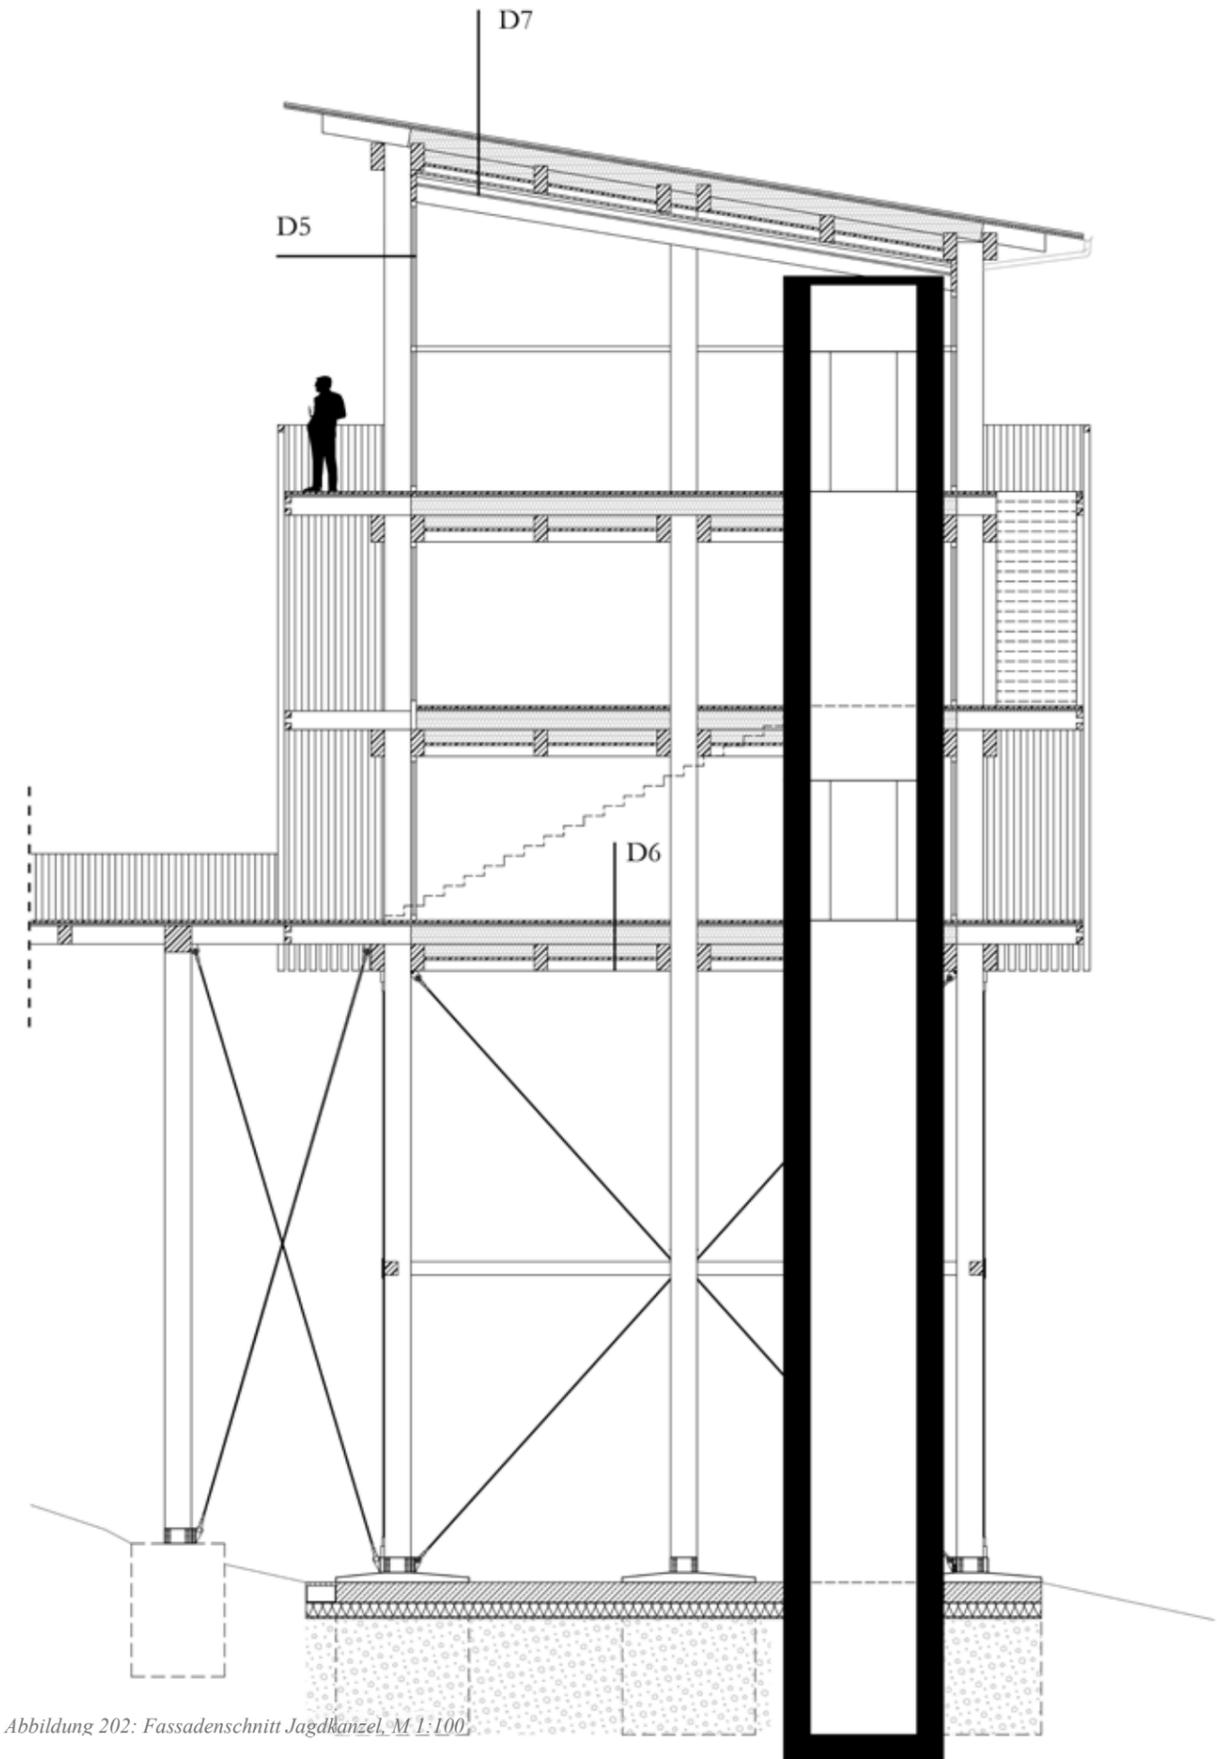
Fassadenschnitt Jagdkanzel, M 1:100
